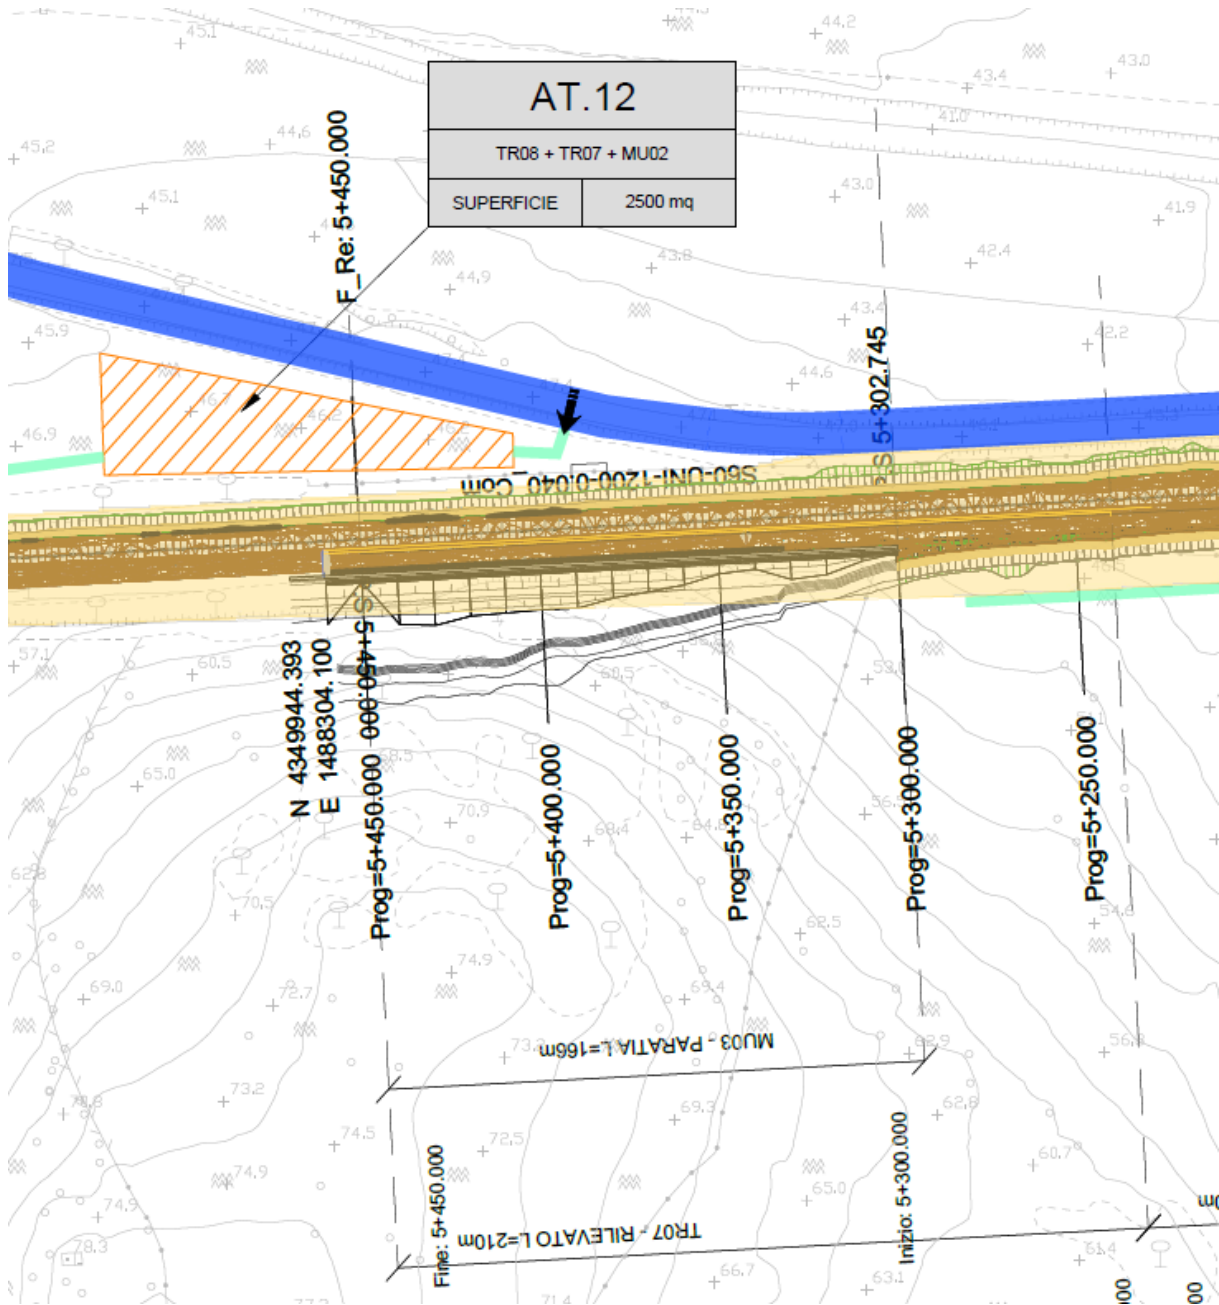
Vista in pianta dell'area di cantiere AT.12
